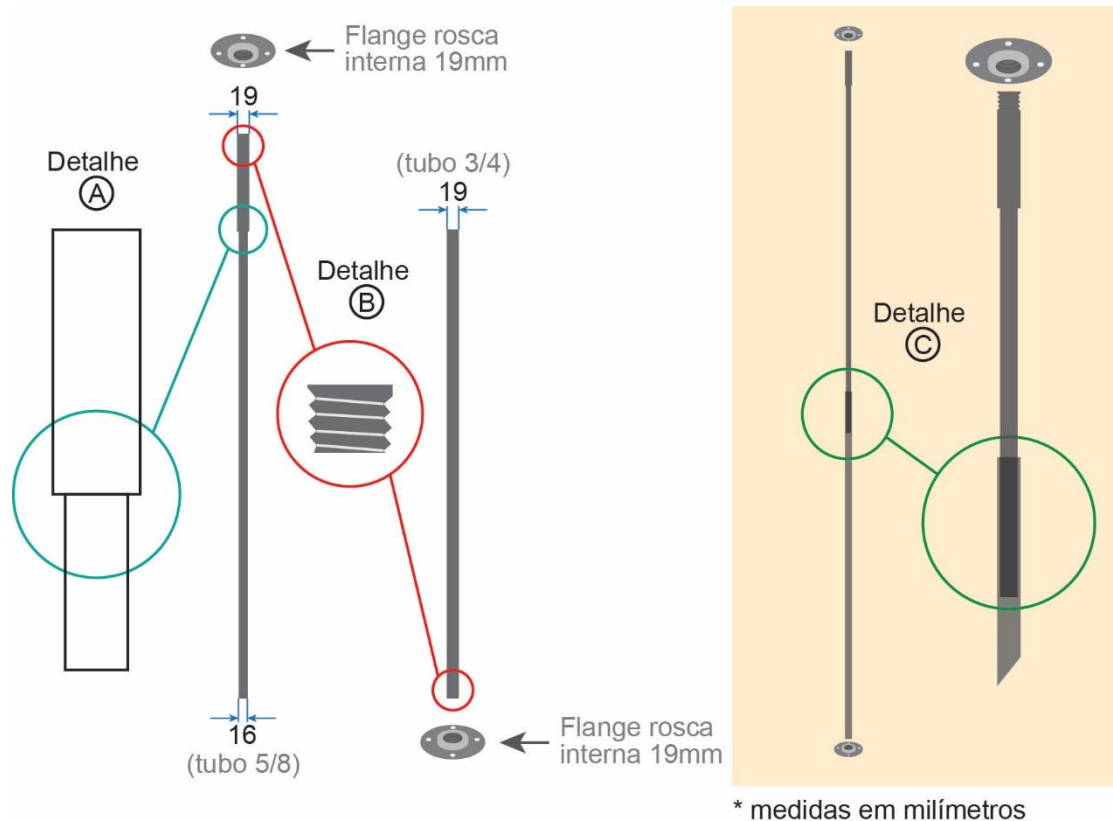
Sistema de instalação de uma parede móvel do piso ao teto
